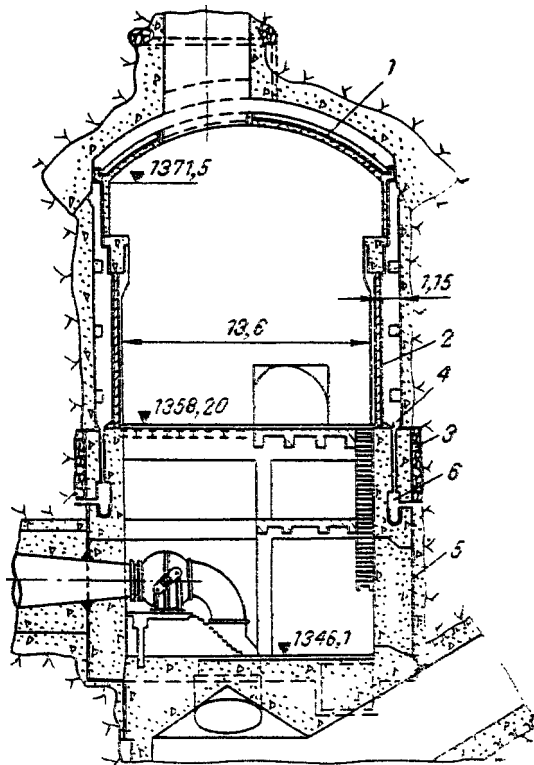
Гидроизоляция и дренаж подземной Севанской ГЭС. Разрез по водовыпуску, [Л. 75, 141]:
